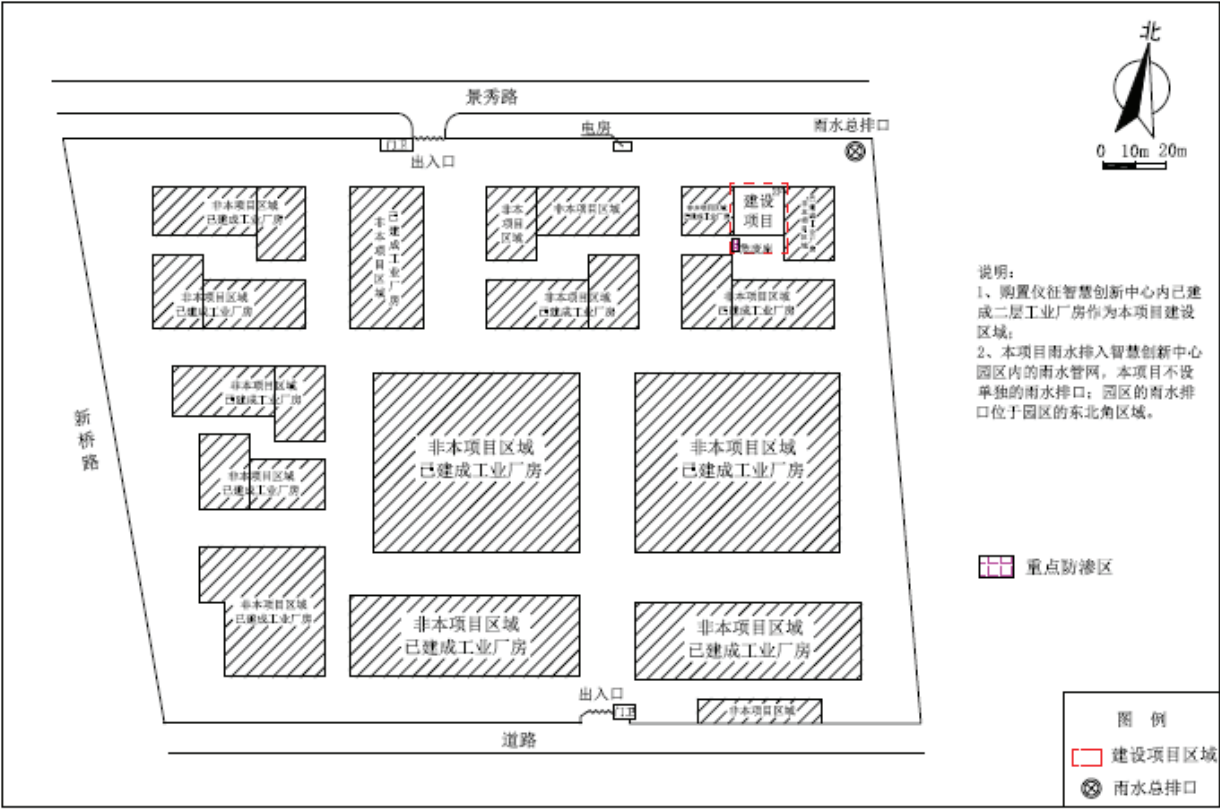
建设项目厂区总平面布置图 (与环评申报基本保持一致)
